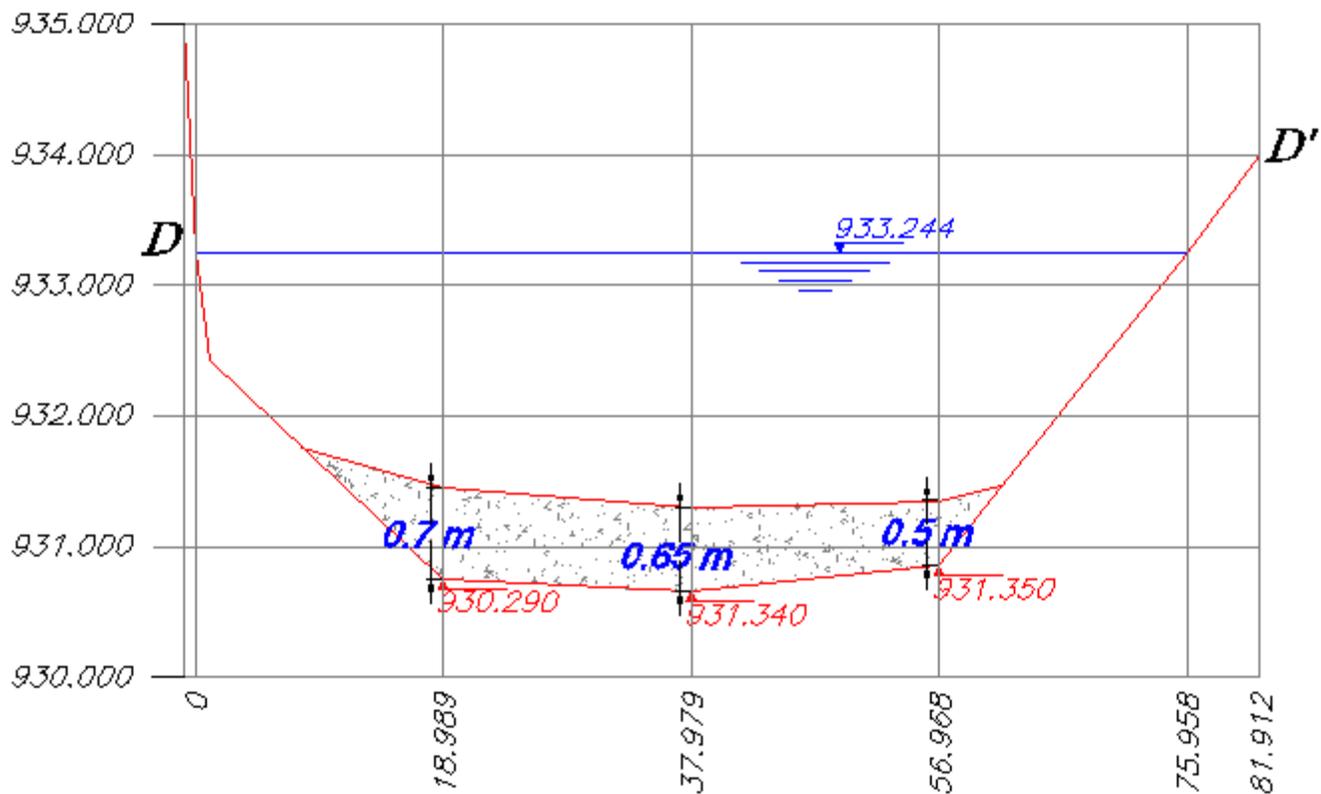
Perfil D – D' Madre Vieja Carabalo.
